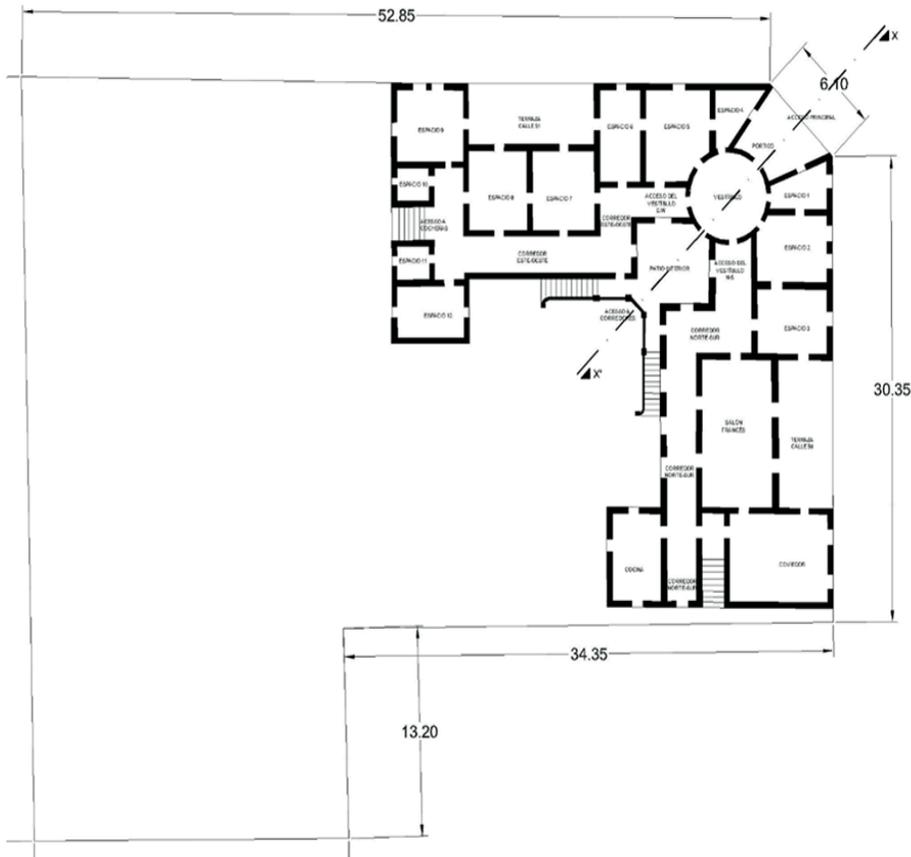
Planta Arquitectónica de la "Casa Morisca"
